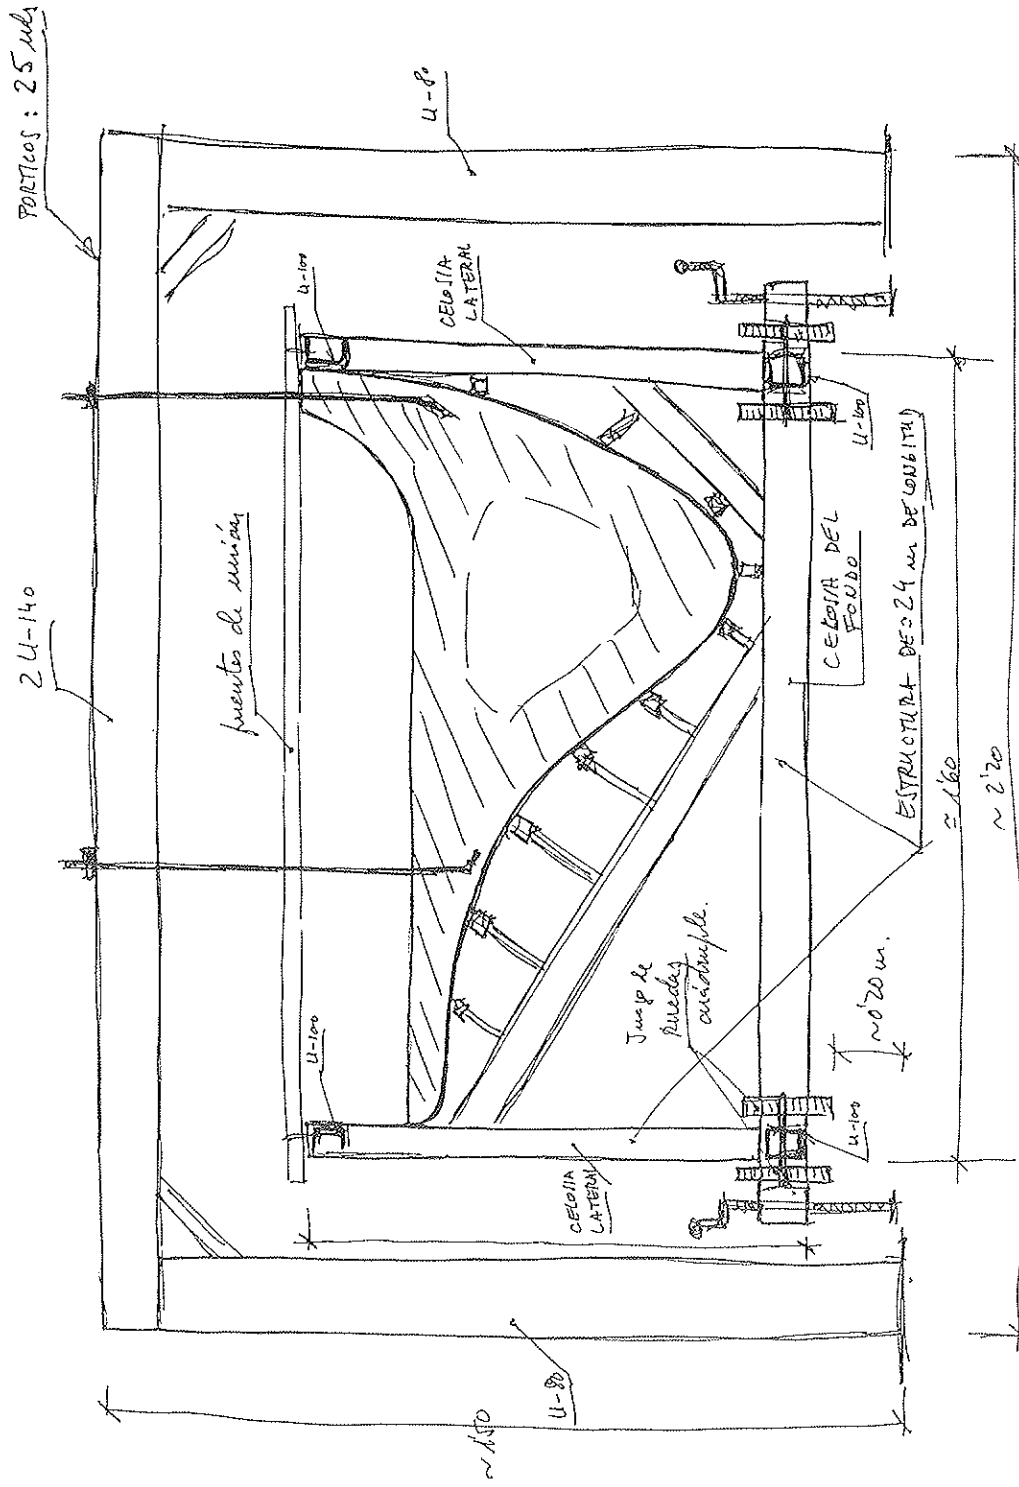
Esquema del molde, con los mecanismos de elevación vertical y desplazamiento longitudinal.
